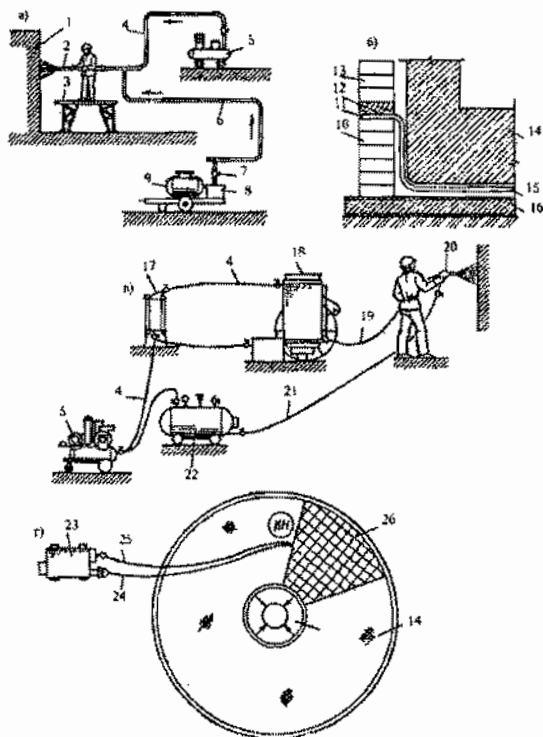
Схема устройства различных видов гидроизоляции: а - окрасочной; б - деталь перехода с горизонтальной оклеечной гидроизоляции на вертикальную; в - цементно-песчаной; г - литой мастично-битумный при гидроизоляции дна радиального отстойника; 1 - изолируемая поверхность; 2 - форсунка; 3 - подмости; 4 - воздуховод; 5 - компрессор; 6 - мастикопровод; 7 - пробочный кран; 8 - насос; 9 - бак для эмульсии или холодной мастики; 10 - защитная стенка в 1/2 кирпича; 11 - слои горизонтального ковра; 12 - доска; 13 - разбираемая часть стенки; 14 - изолируемое сооружение (резервуар); 15 - защитный слой из цементно-песчаного раствора; 16 - бетонная подготовка; 17 - воздухоочиститель; 18 - цемент-пушка; 19 - материалный шланг; 20 - сопло; 21 - водяной шланг; 22 - бак с водой; 23 - передвижная кровельная установка ПКУ-35М; 24, 25 - шланги для подачи соответственно сжатого воздуха и мастики; 26 - готовый участок гидроизоляции; 27 - коническая часть дна отстойника
